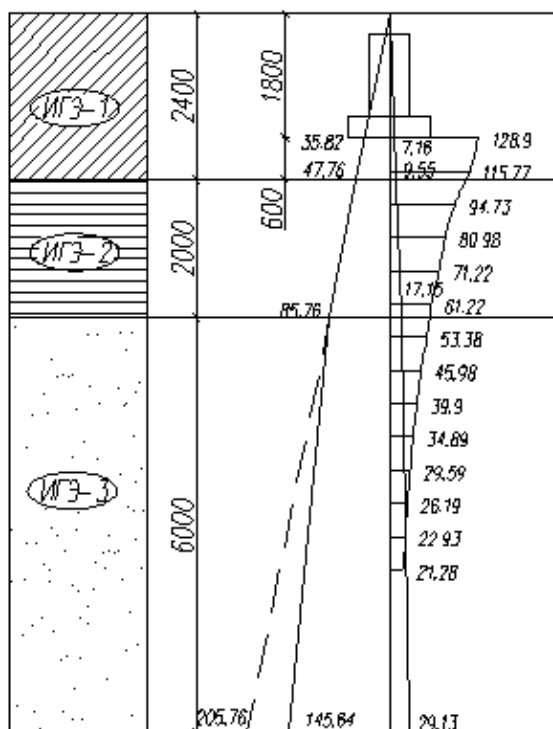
Результати розрахунку осадок фундаменту (ФМЗ-1)
